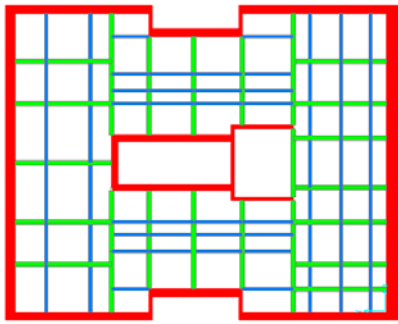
Malha de perfis metálicos (azul – HEA200, verde – HEA300).
